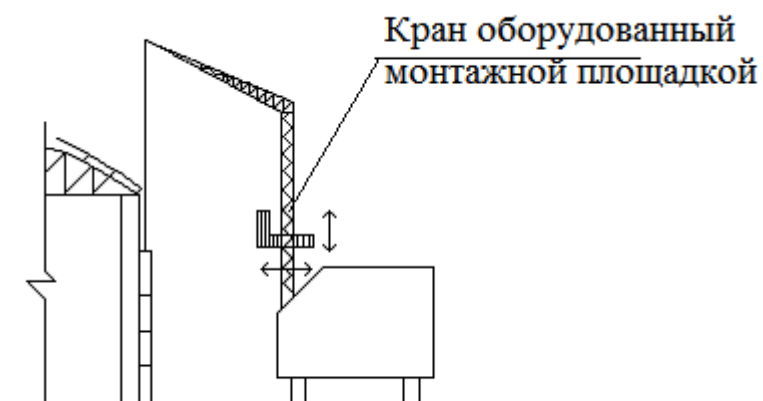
Монтаж стеновых панелей краном, оборудованным монтажной площадкой
